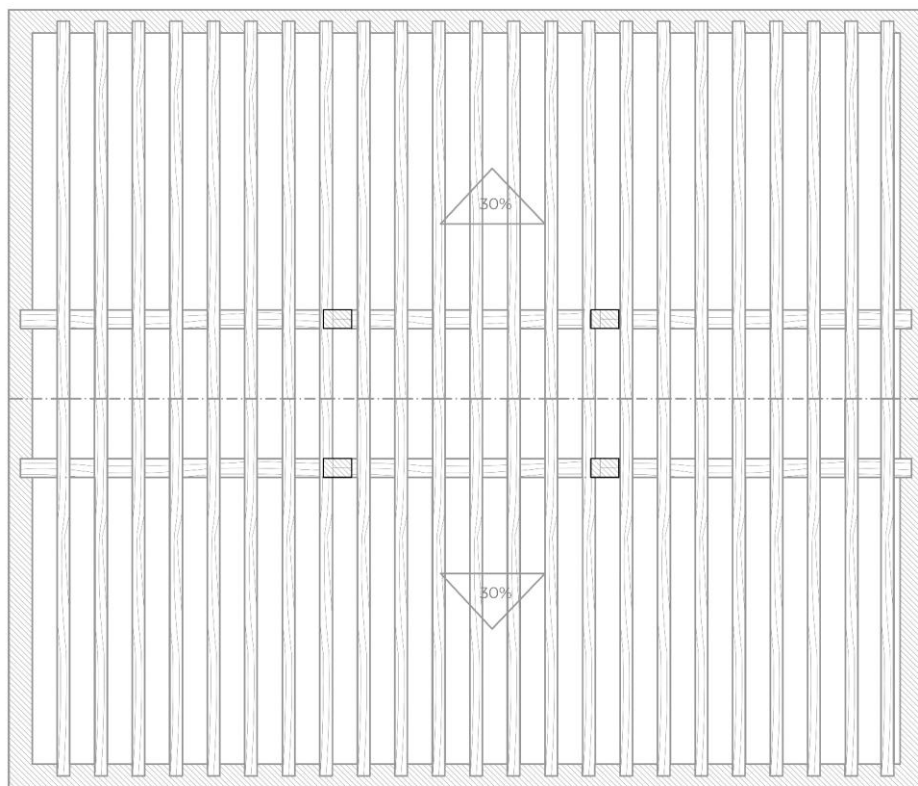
Detalle sección constructiva 1. Fuente: Elaboración propia.
